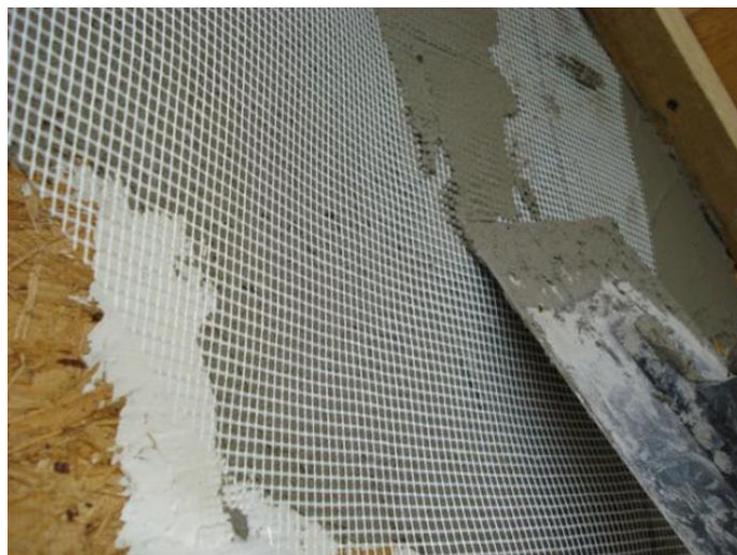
Установка армирующей сетки с обработкой поверхности грун-
